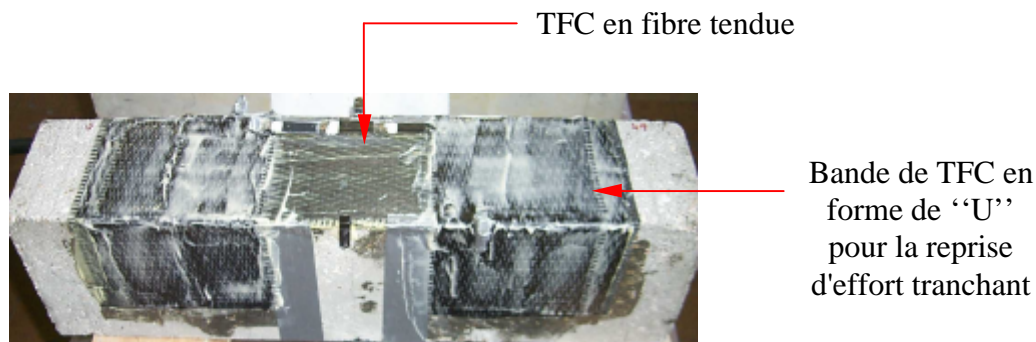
Renforcement par TFC d'une poutre pré-fissurée (vue de dessous)
